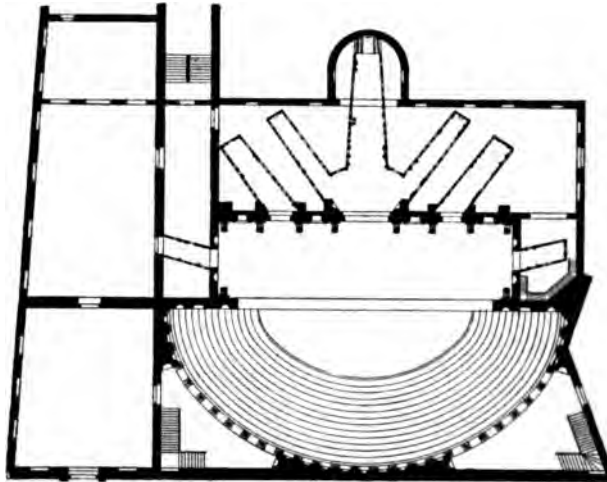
Palladios Teatro olimpico zu Vicenza. Grundriss. (Nach Gurlitt.)
